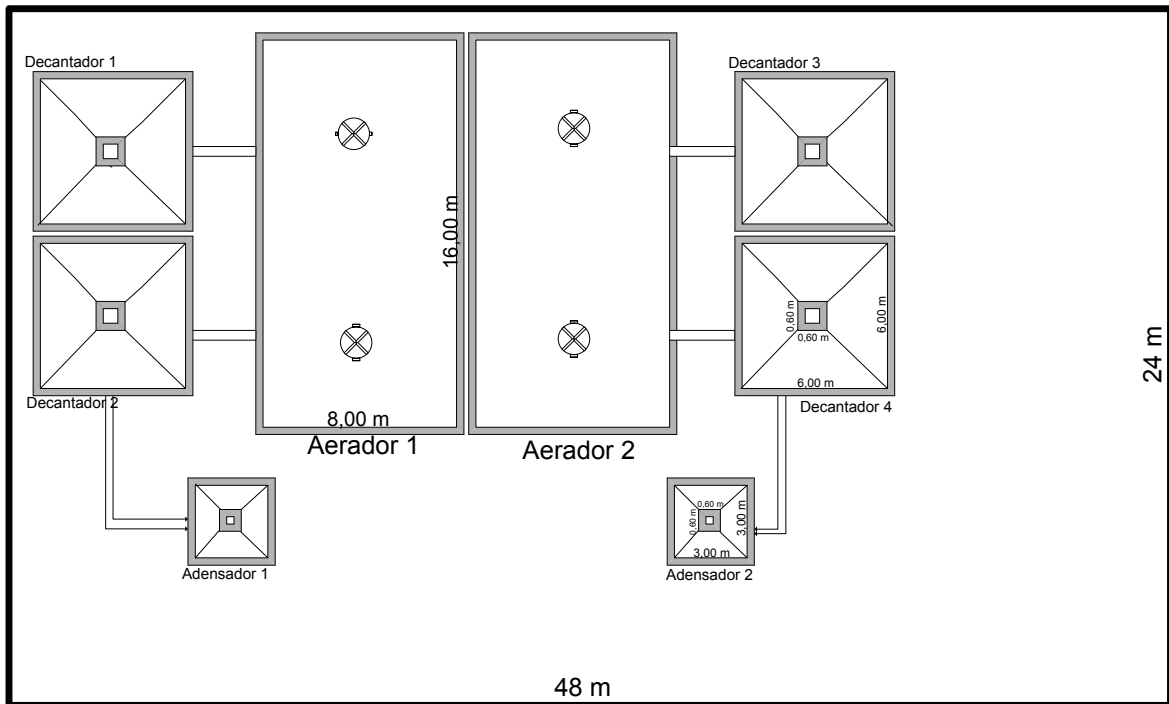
Planta Baixa da ETE de Lodo Ativado
